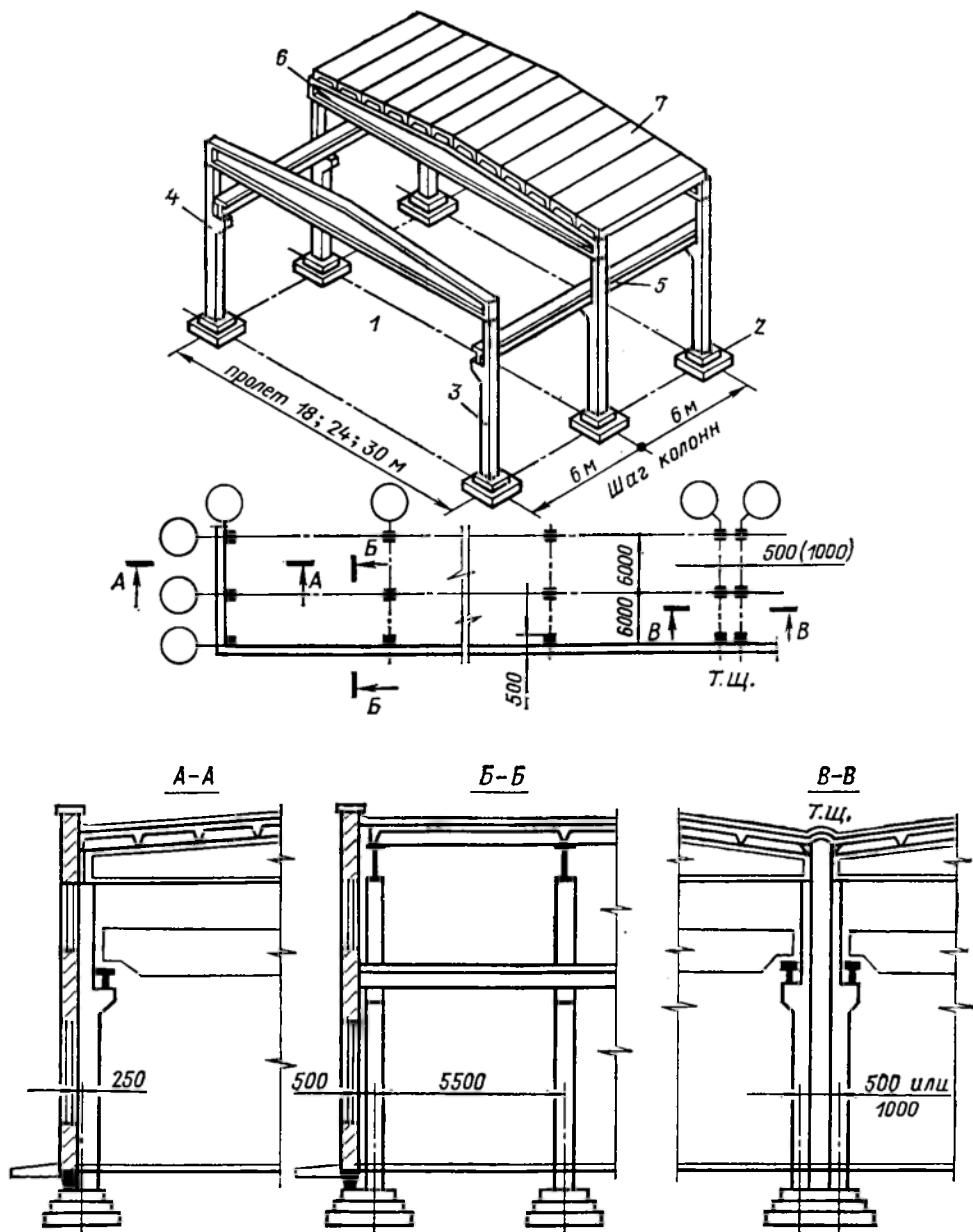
Конструктивная схема производственного здания, оборудованного кранами:
